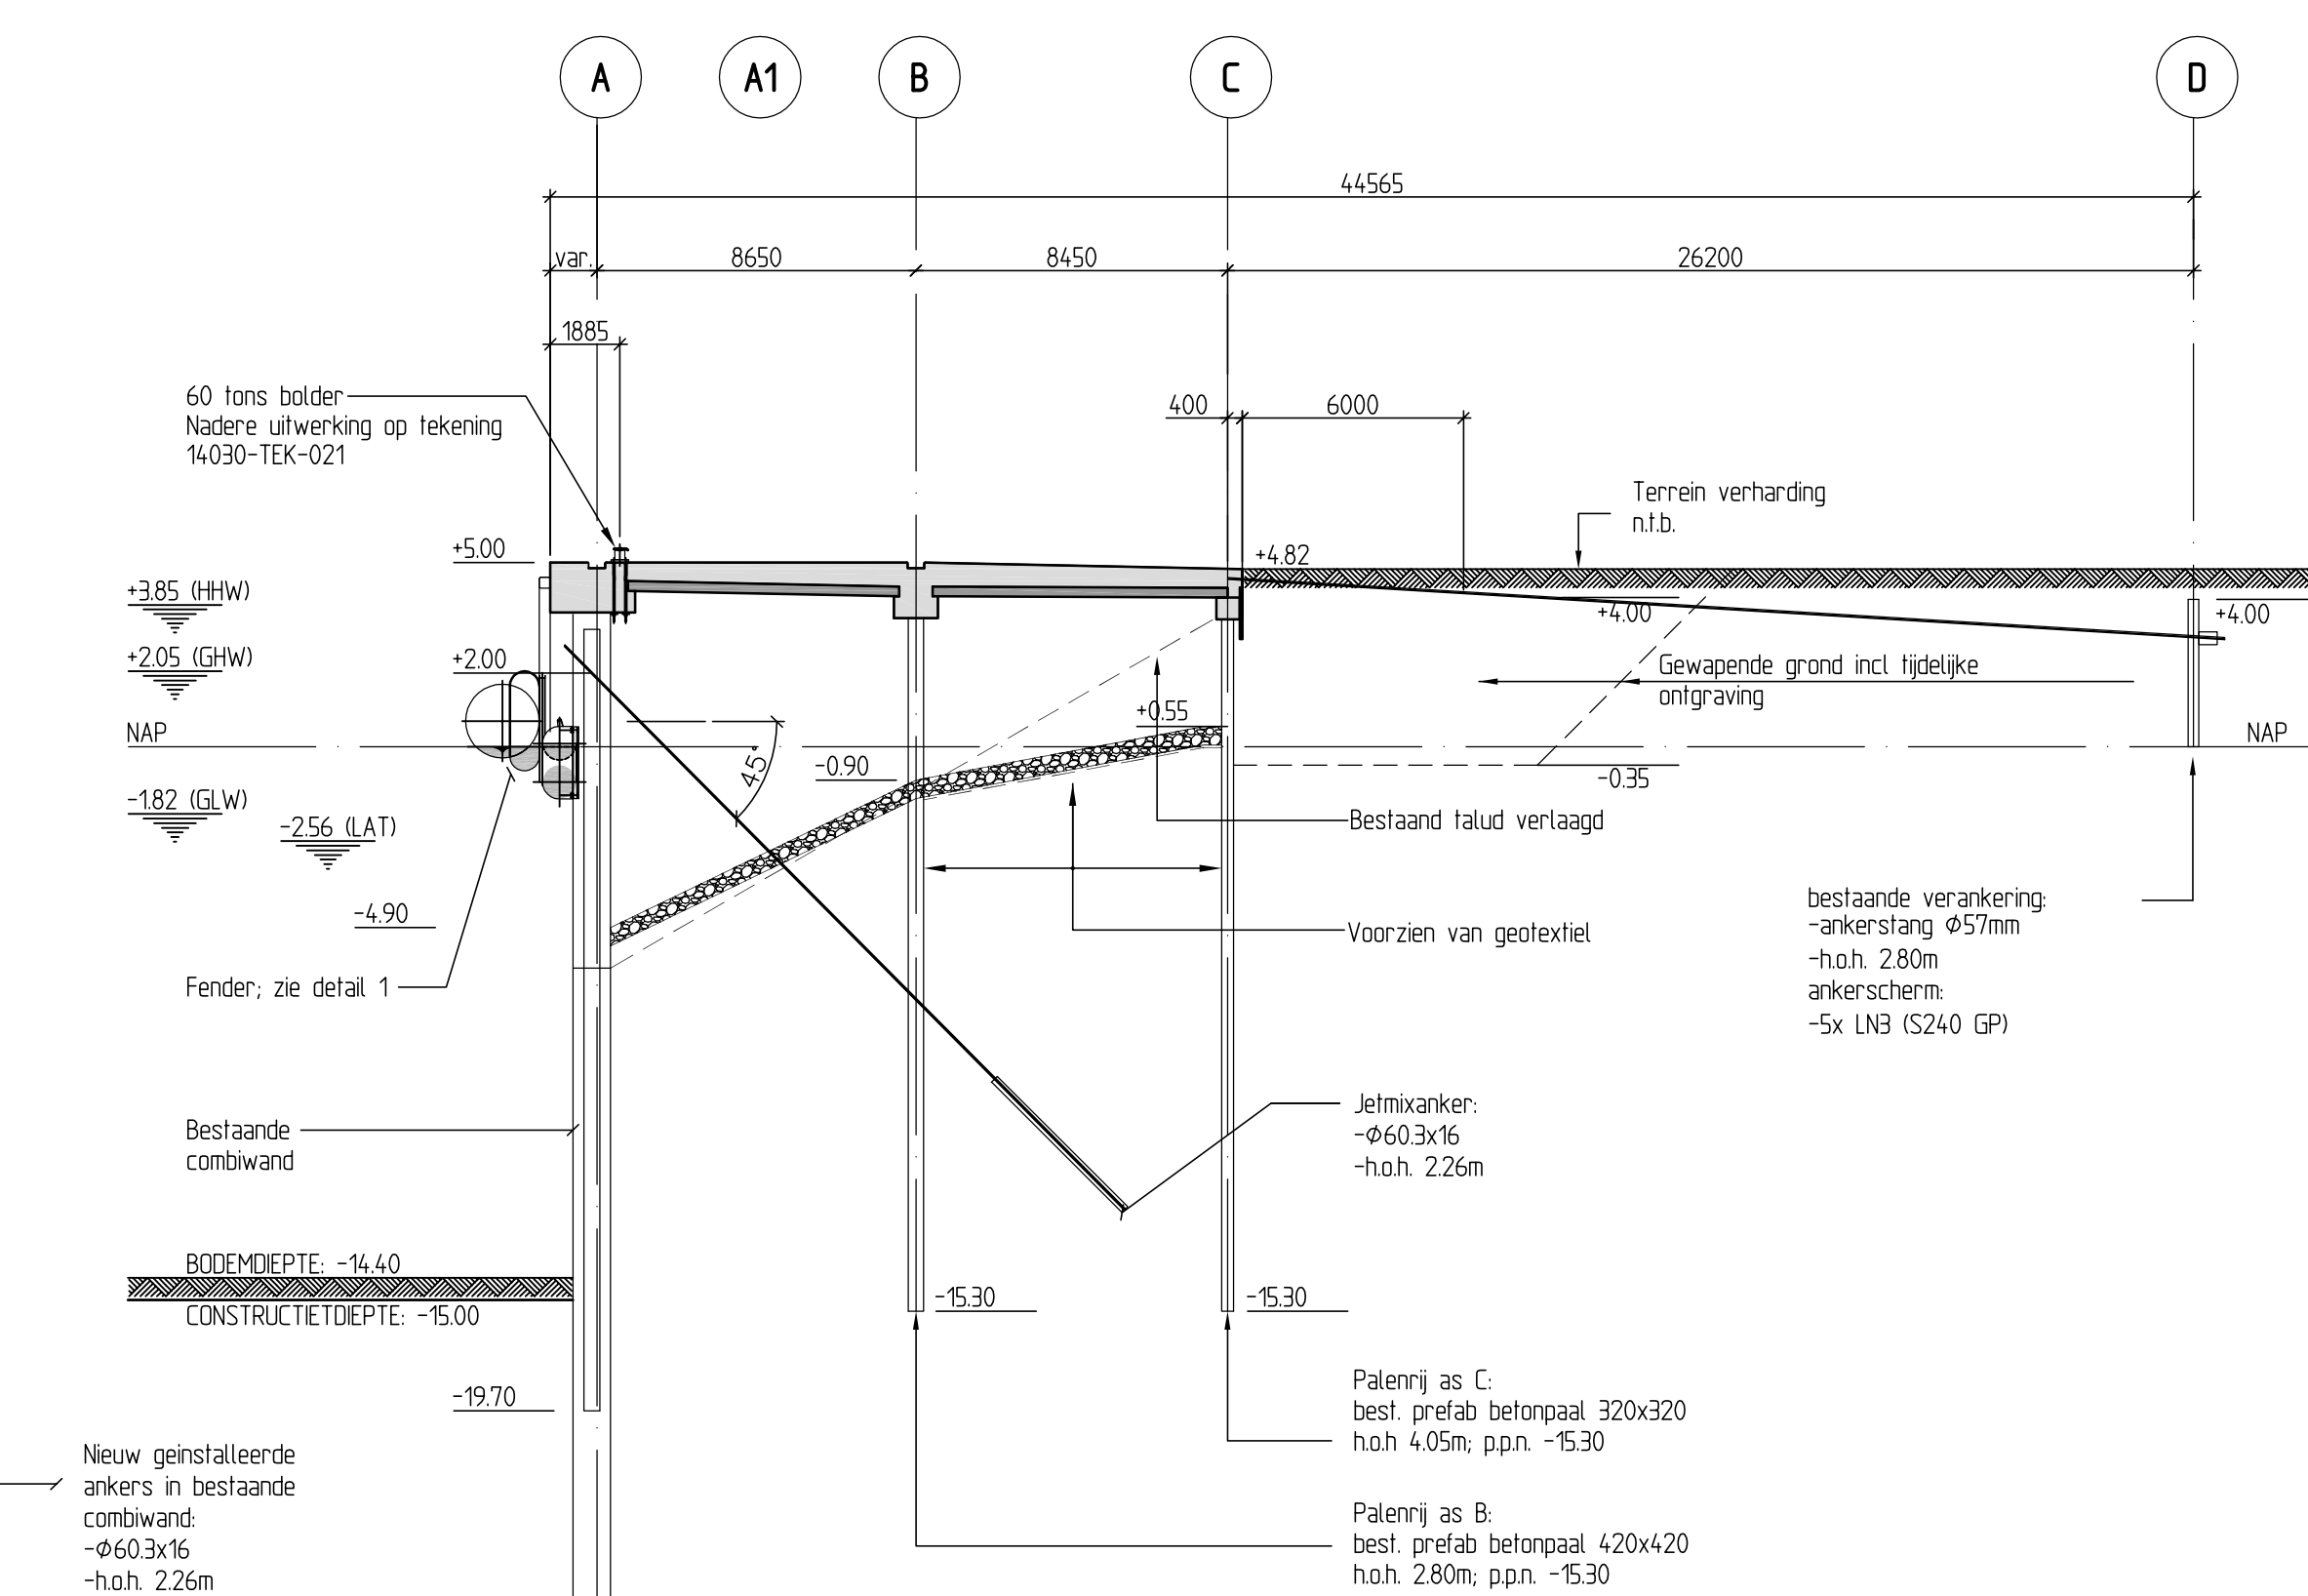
DETAIL: DOORSNEDE STANDAARD ANKERDOORVOER
